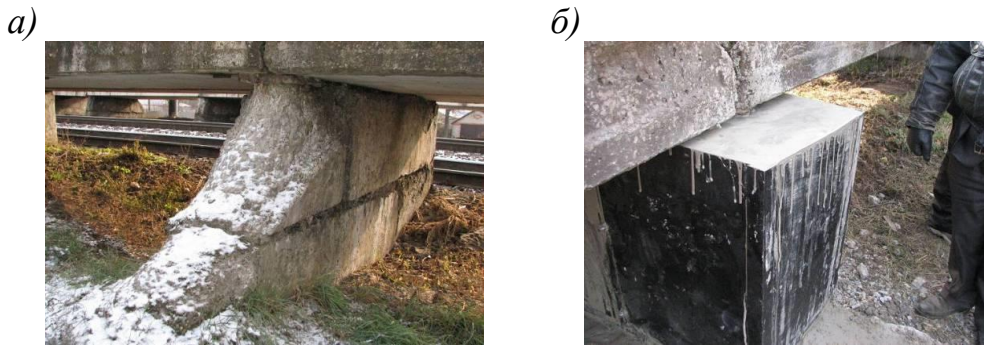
Бетонна опора високої пасажирської платформи на з.п. Зелений Гай Південної залізниці: *а)* руйнування бетонної опори; *б)* підсилення за допомогою сталобетонної напівобойми
